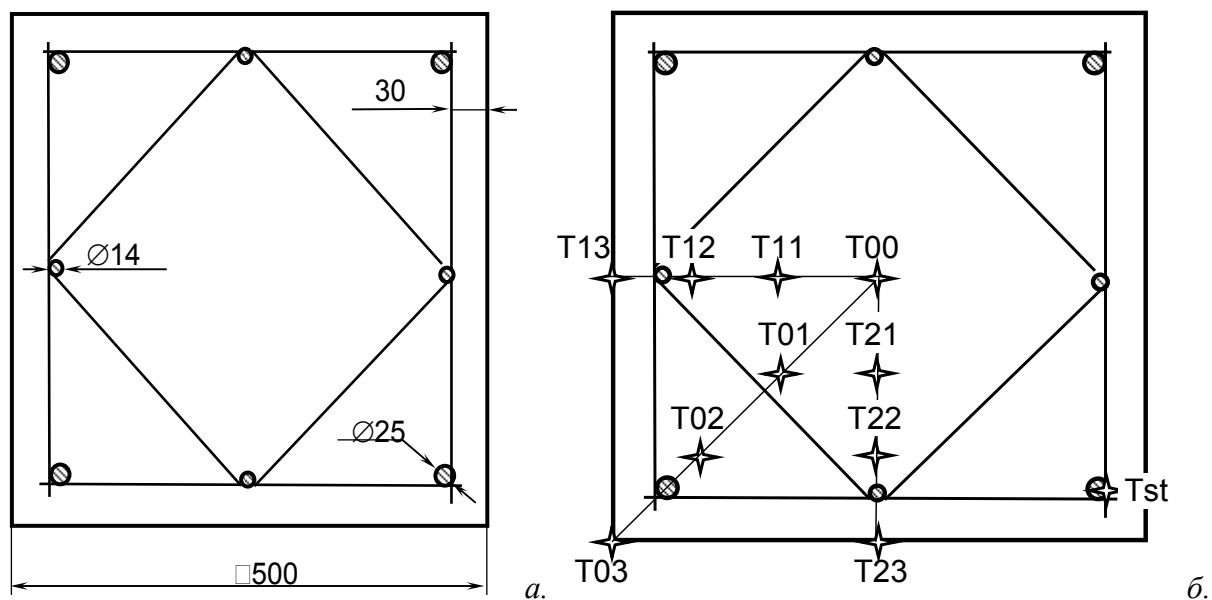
Схема армування (а) та схема розташування термопар (б) залізобетонної колони
